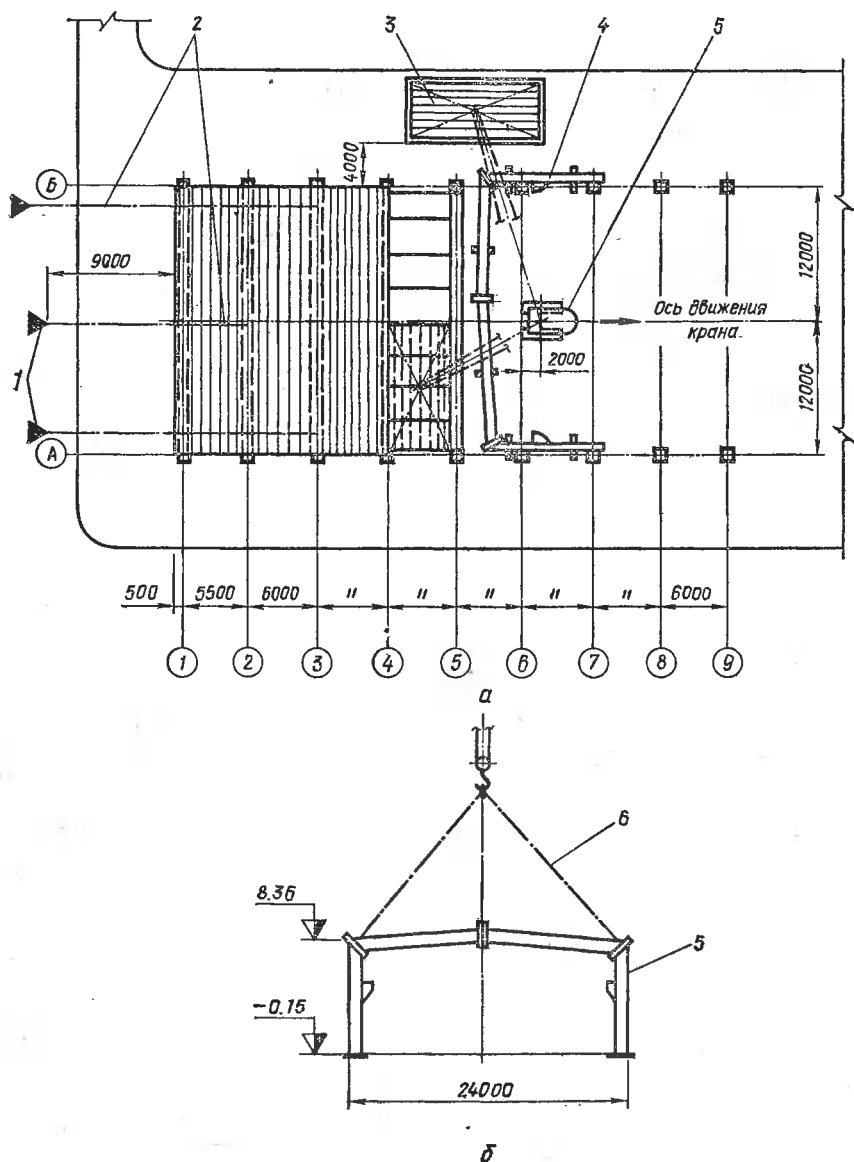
Схема монтажа рамных конструкций типа «Плаузи»:
